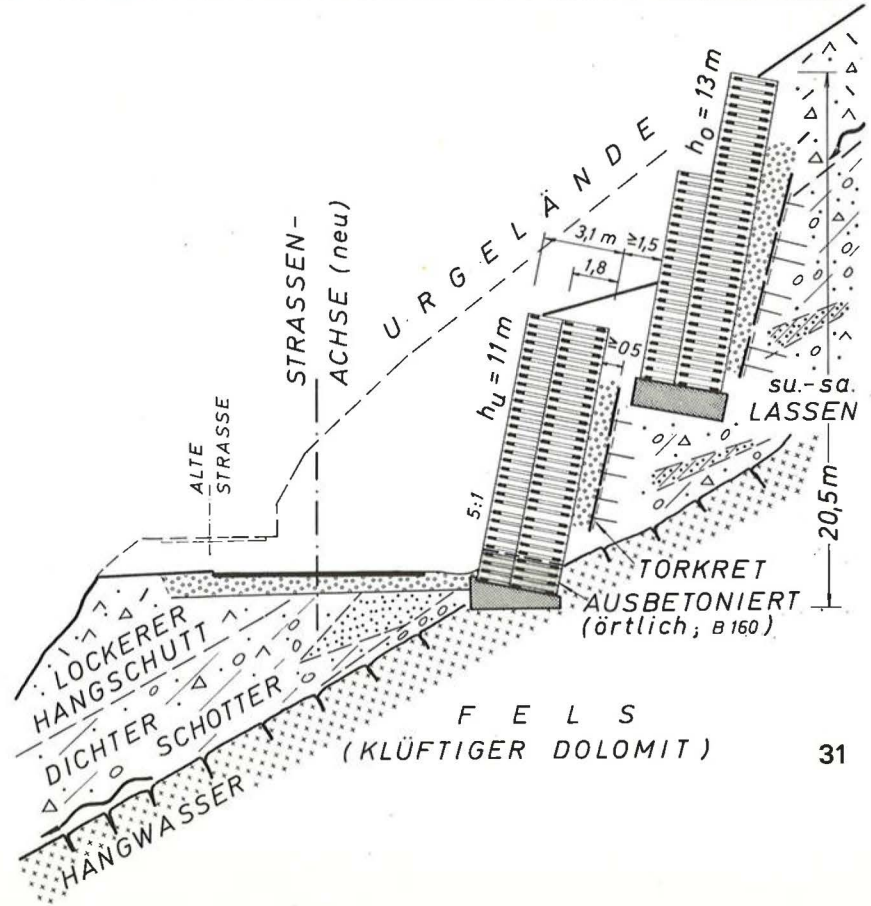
Gestaffelte Raumgitterstützmauern im Steilgelände; unterster Mauerbereich örtlich mit Filterbeton ausbetoniert (zur Vermeidung einer Überbeanspruchung der Fertigteilknoten)
